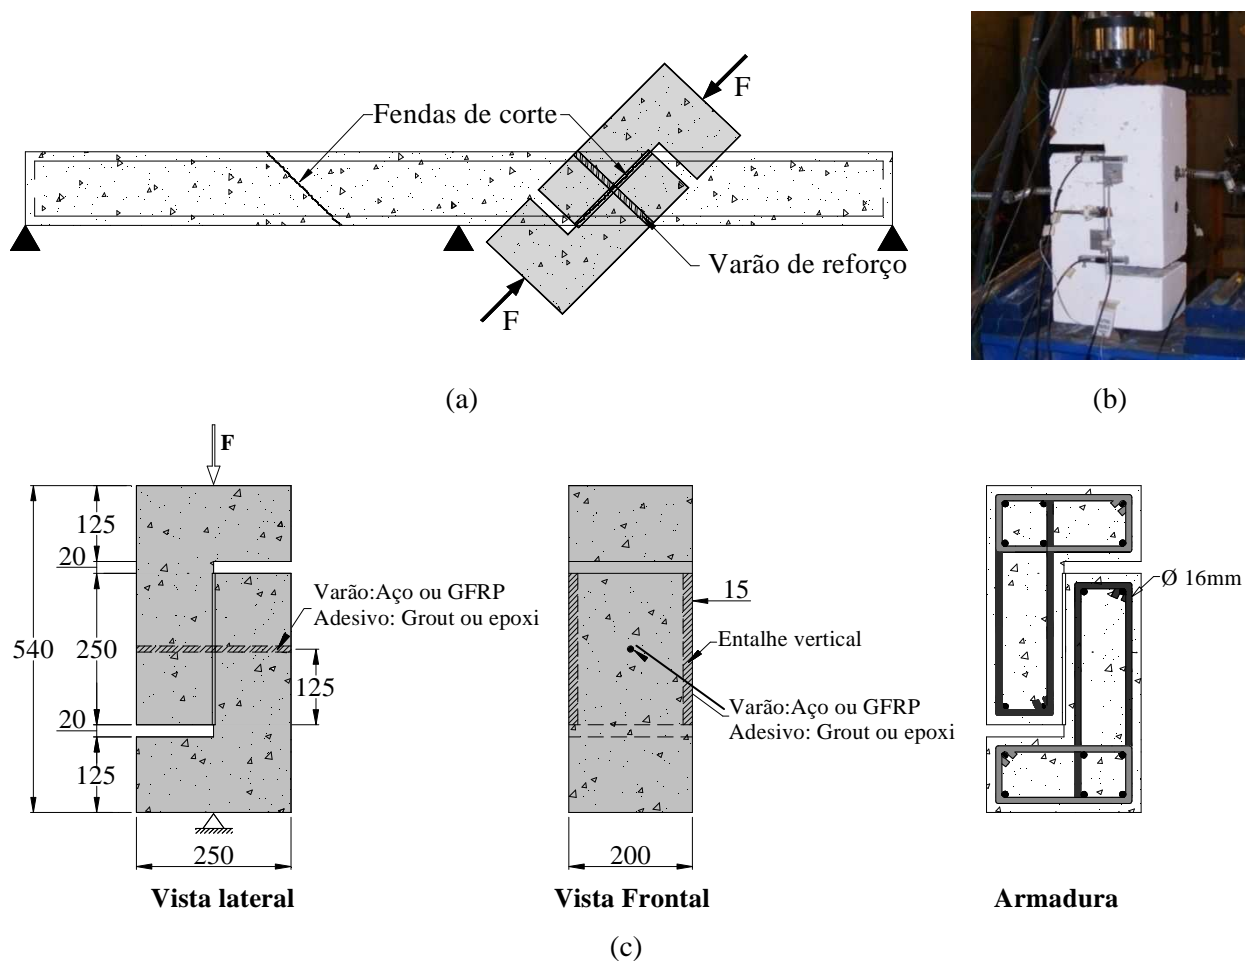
(a) Conceito, (b) foto do ensaio e (c) geometria e armaduras comuns a todos os provetes. (dimensões em mm)
